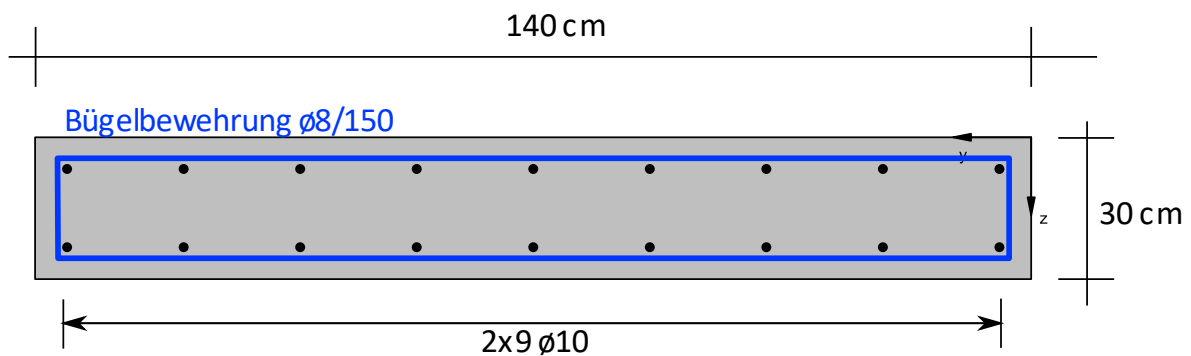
Geschätzte Bewehrung Wandscheibe BW2
